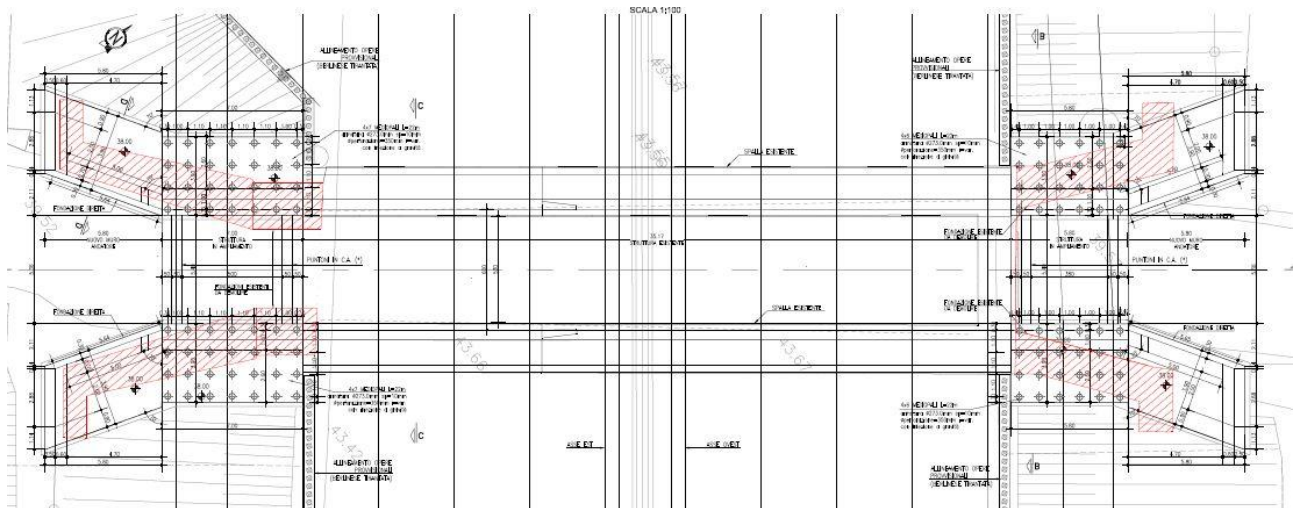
Planimetria di progetto opere di fondazione.
